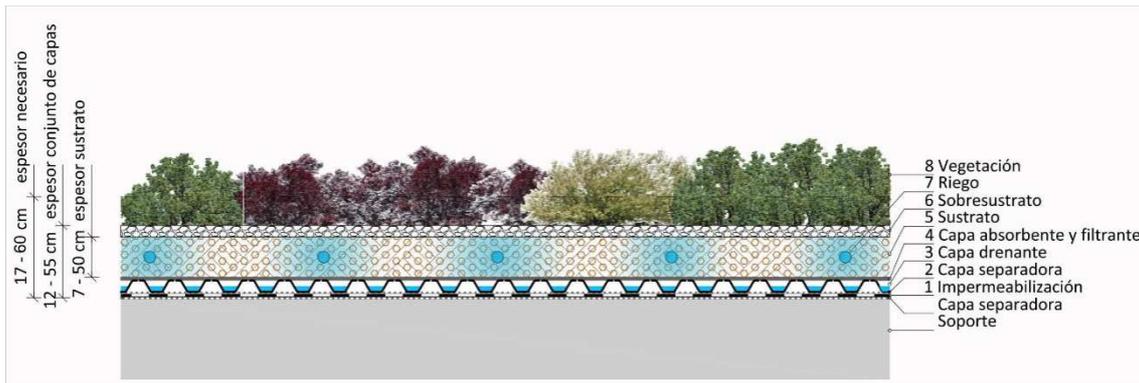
Detalle constructivo Cubierta vegetal Cántir [2]
